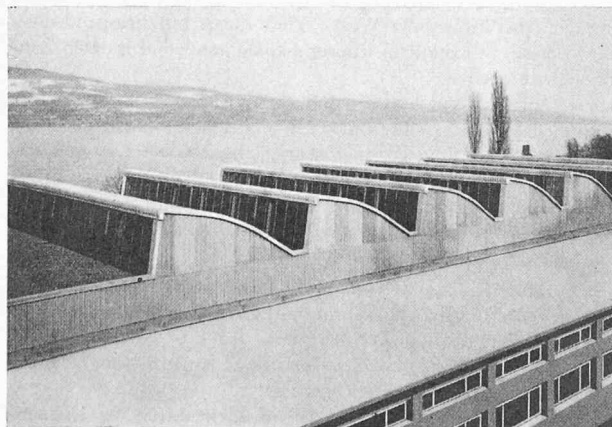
Schalterhalle mit gewöhnlichem Glas abgedeckt, darüber Thermex-Glas-Dach
